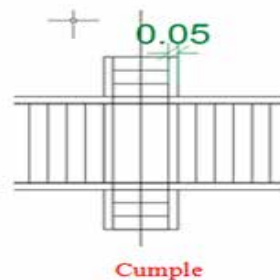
Detalle en Vigas de dimensiones de zonas de confinamiento.
